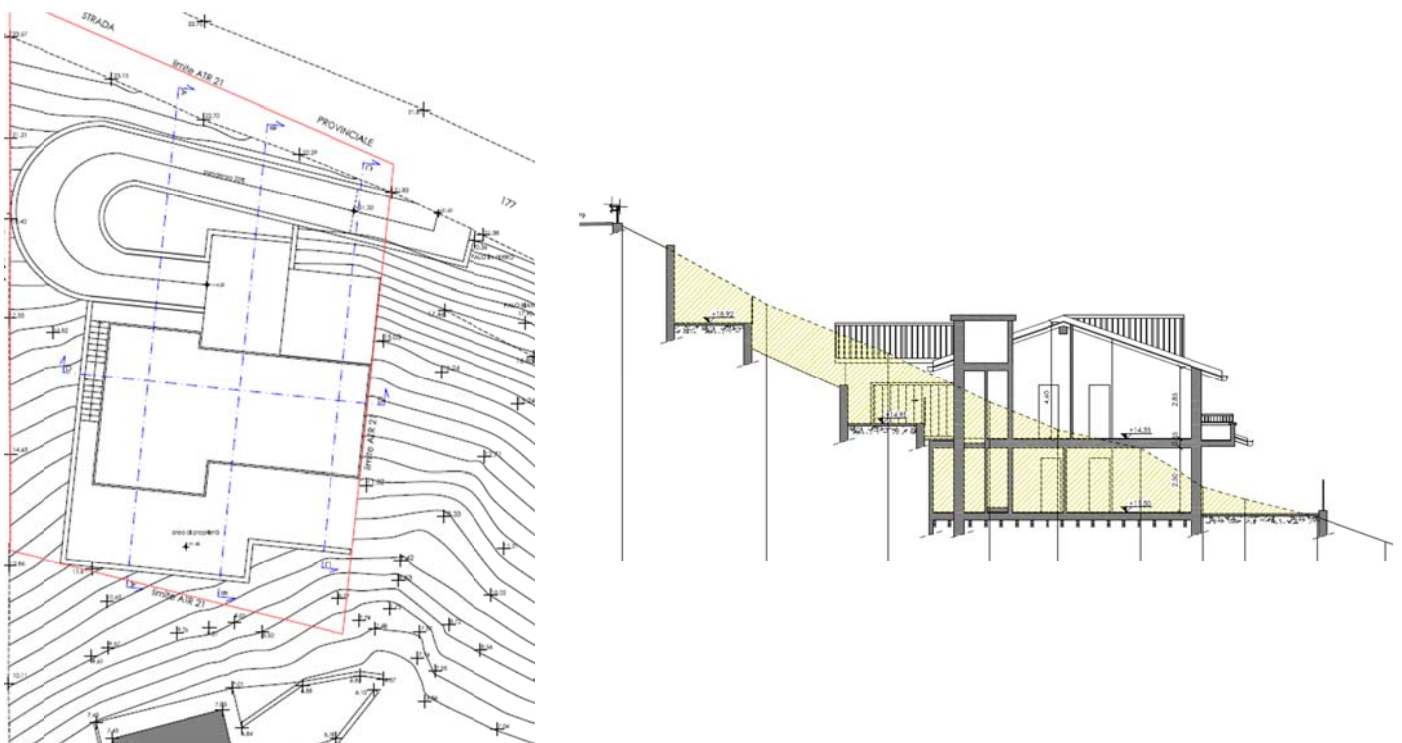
estratto planimetria e sezione c-c di progetto. Scala grafica.
